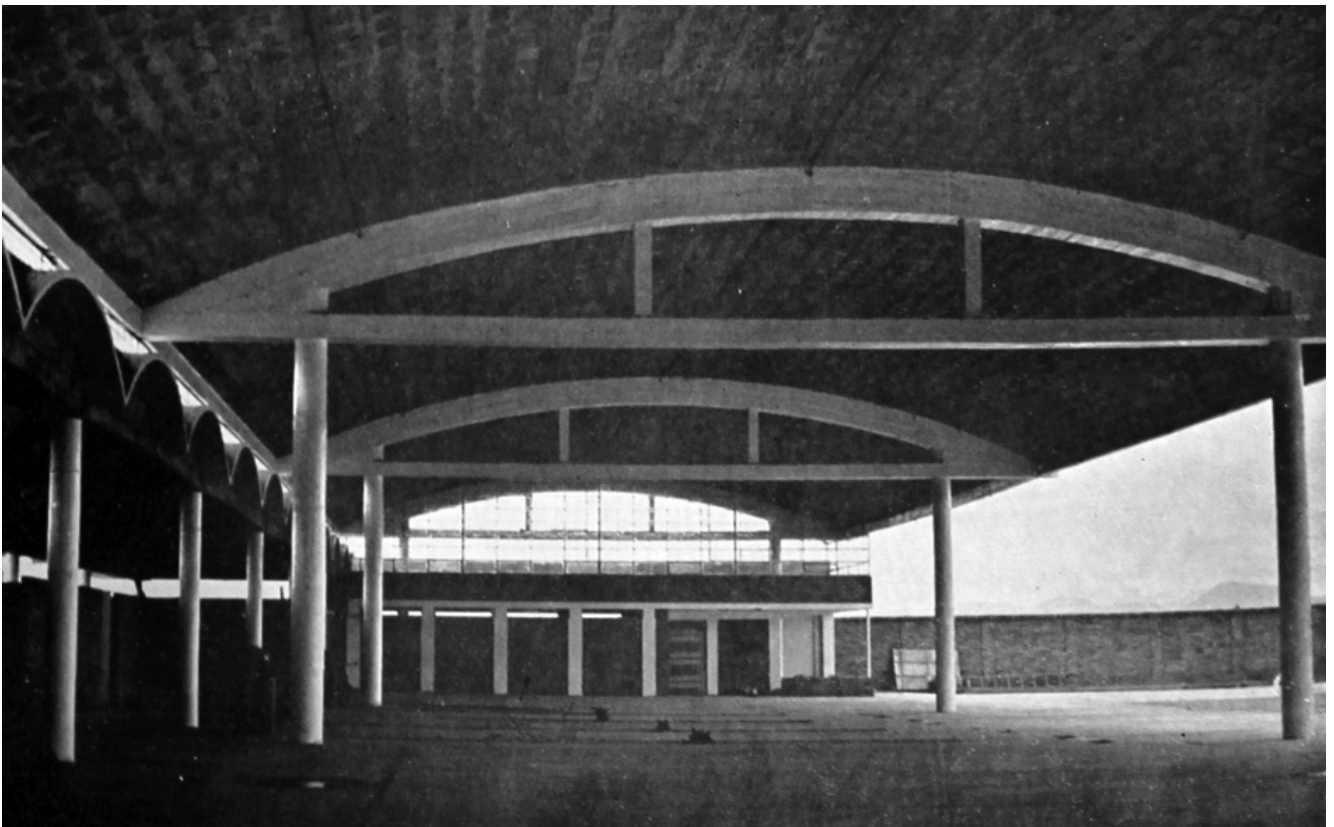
Vista de las 3 bóvedas alineadas, apoyadas sobre arcos atirantados en la estación de autobuses en Bogotá; a la derecha, serie de 14 bovedillas. Fuente: archivo particular.
